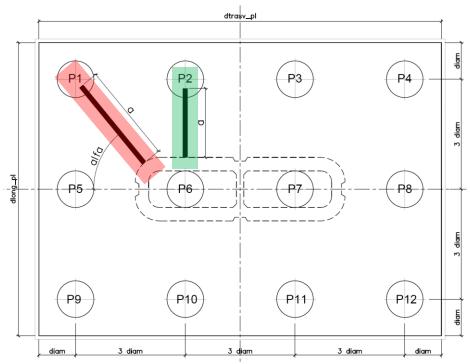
Vista in pianta - Tirante-puntone longitudinale (verde) e diagonale (rosso)
